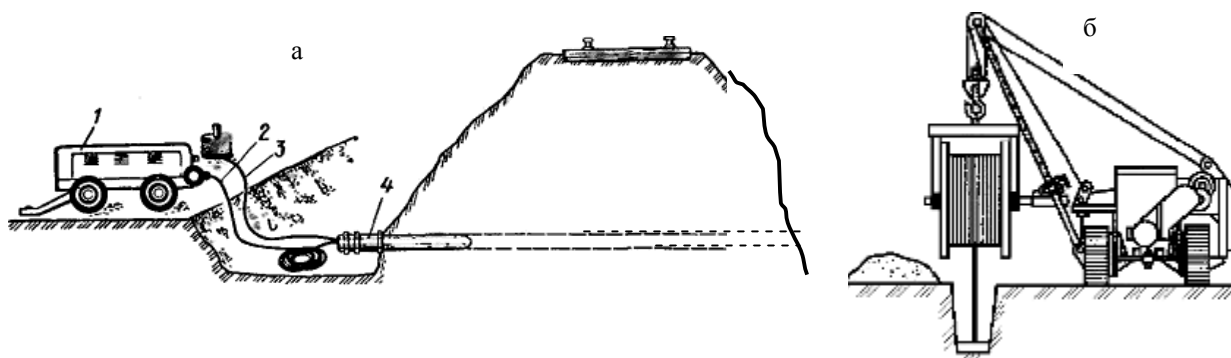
Схема прокалывания ж/д насыпи для укладки трубы и кабеля (а).
